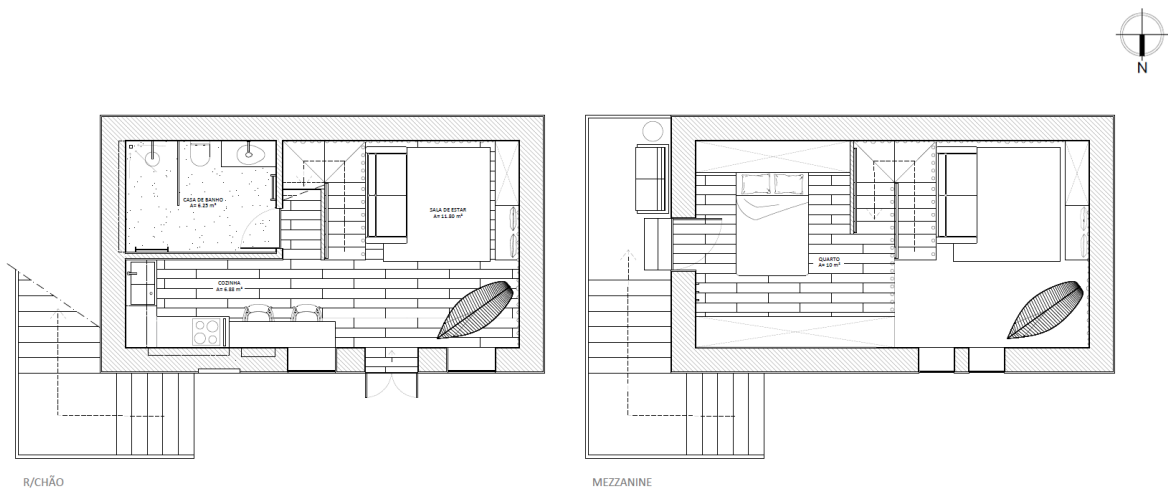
Planta de Apresentação, Alojamento Til, R/Chão e Mezzanine.
